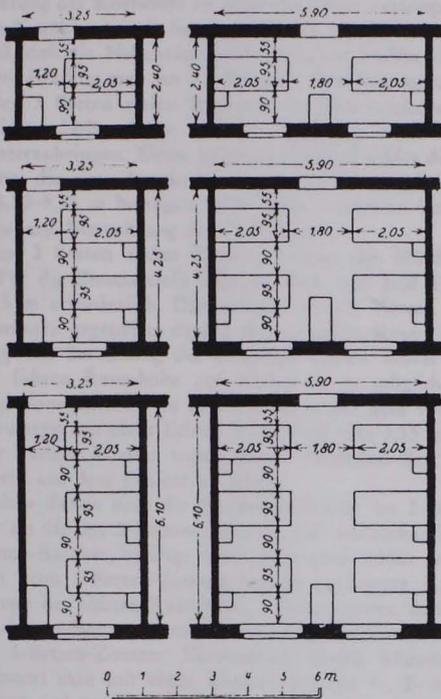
Geringster Flächenbedarf bei der Bettenaufstellung parallel zur Fensterwand bei 1, 2 und 3 Betten tiefen Zimmern unter Einhaltung der vorgeschriebenen Grundfläche von 7,5 qm je Bett. Nach Winterstein
